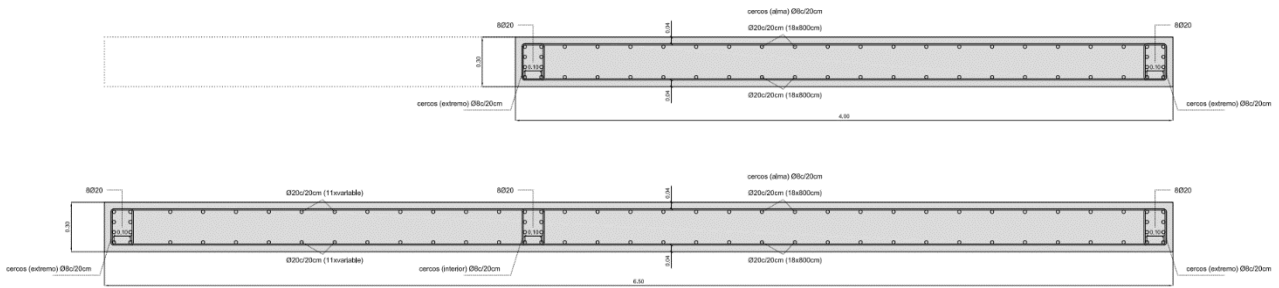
Sección de muro M.01 en tramo inferior con armado. Fuente: David Gallardo.
